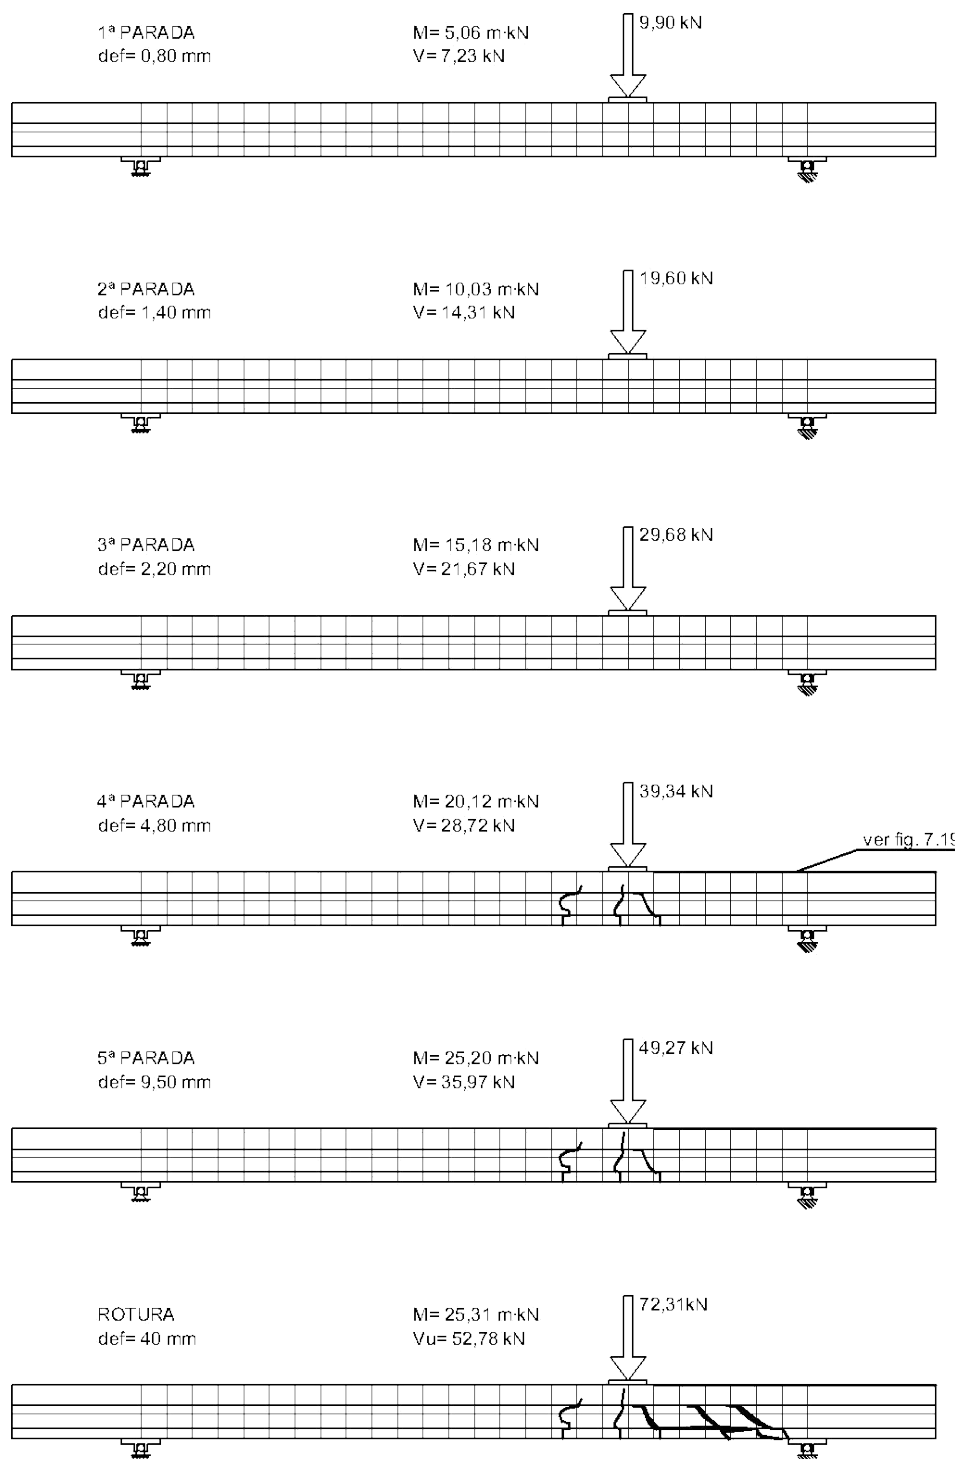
Control de fisuración, 20-T5-T12-CC8.
